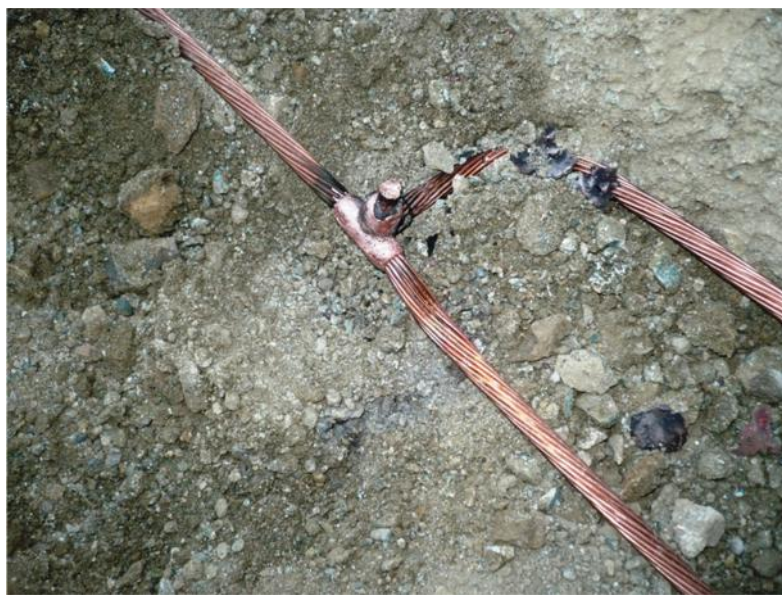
Unión cable – varilla utilizando soldadura exotérmica
